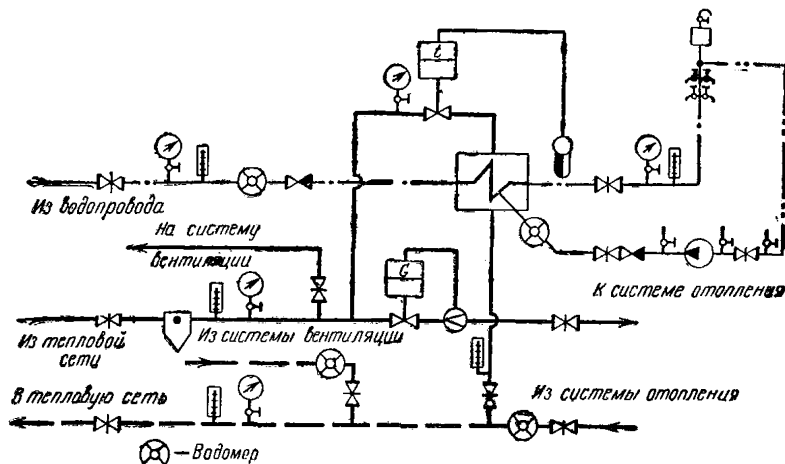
Схема установки водометров для учета тепла на тепловом пункте в закрытой водяной тепловой сети.
